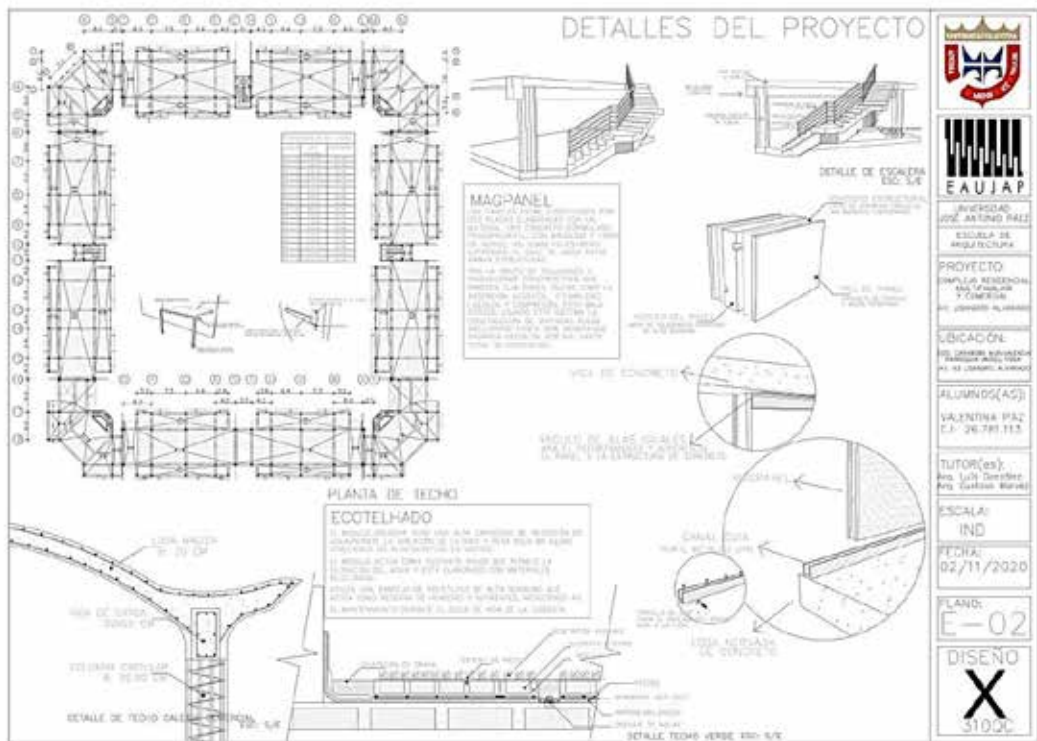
Estructura. Detalles Constructivos. Autora (2020).
